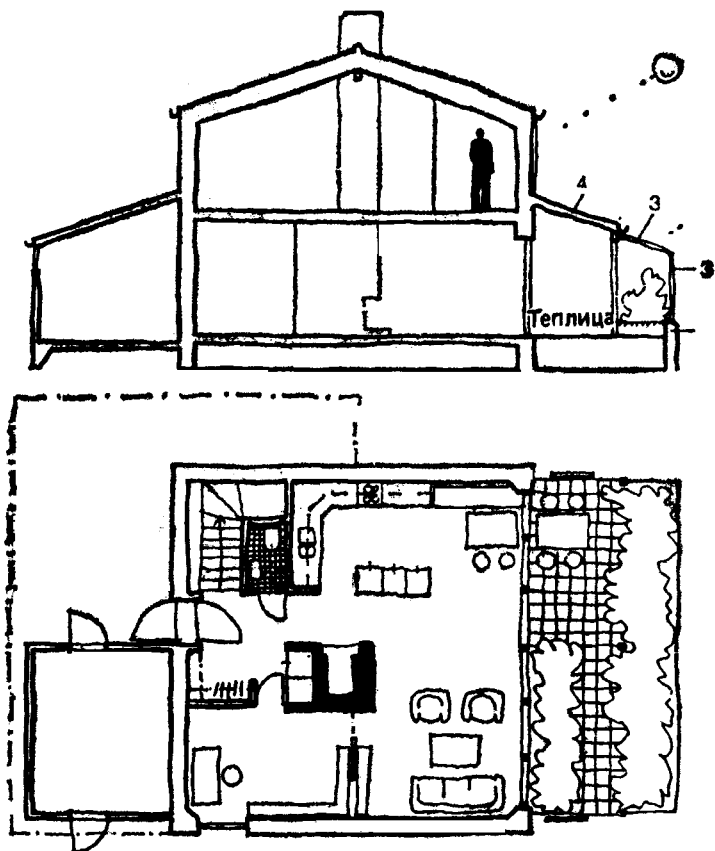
Жилой дом в Куопио, поперечный разрез и план
